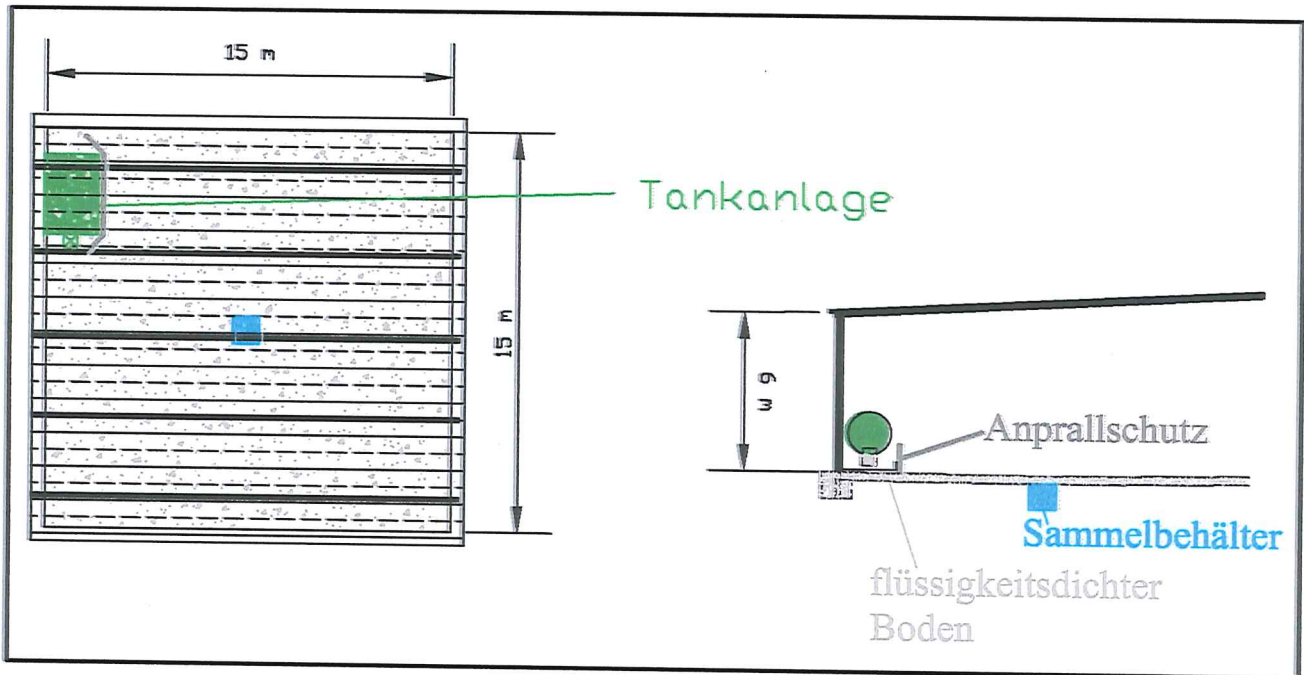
Abstell- und Betankungsfläche mit stationärer Betankungsanlage – grundrissliche Darstellung und Seitenansicht
